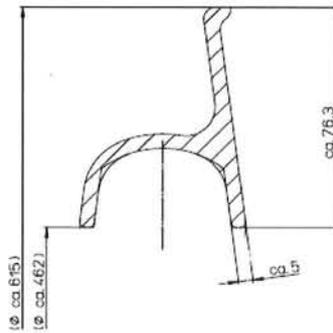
Vue en coupe joint rehausse – dalle de répartition
